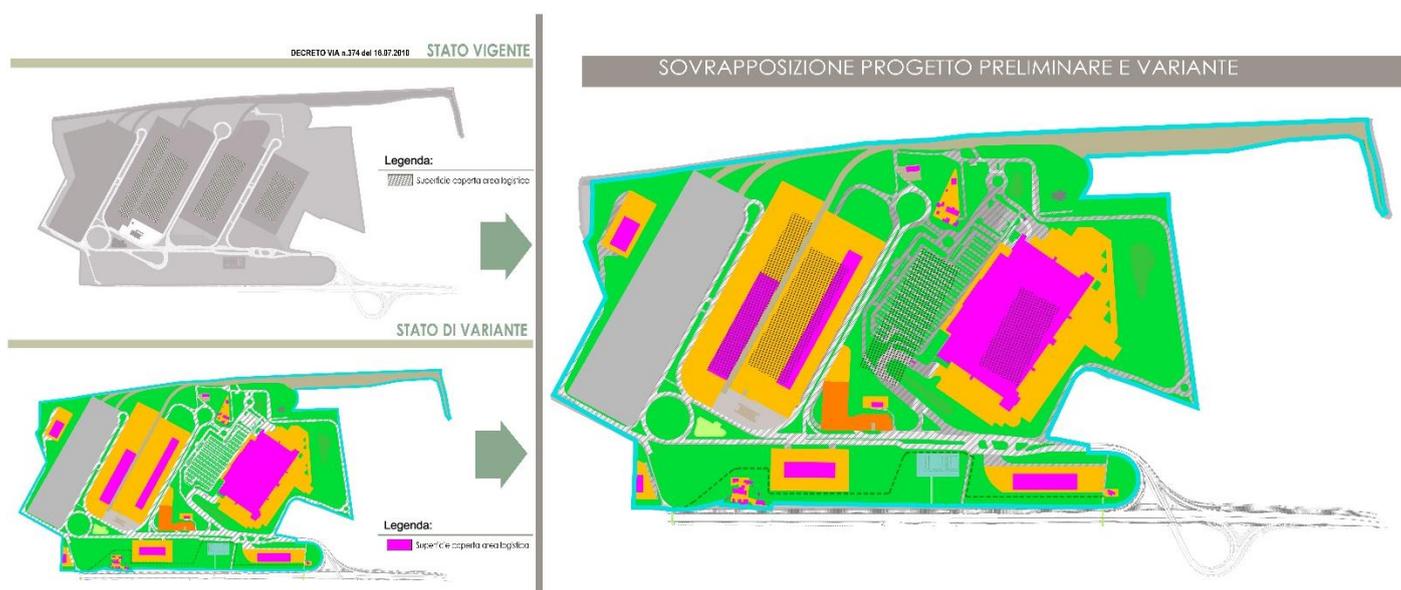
Planimetrie di confronto stato vigente (VIA 2010) e stato di variante e sovrapposizione dei due scenari
